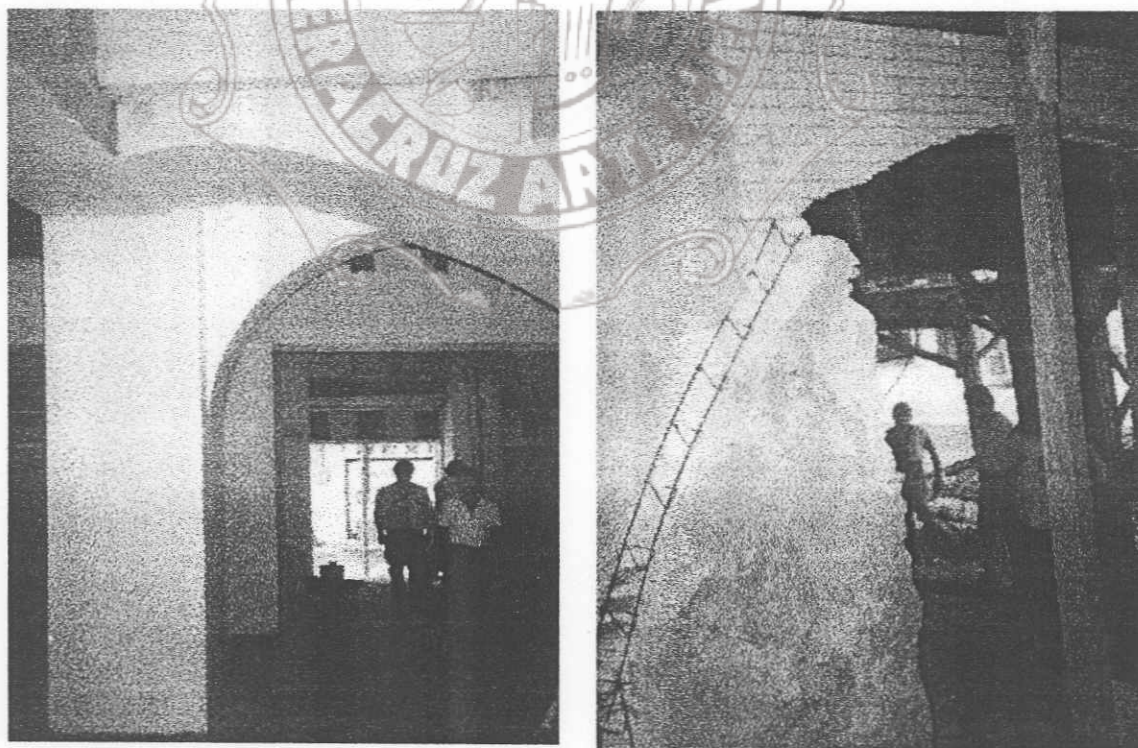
Muros eliminados y transformados en planta baja.
